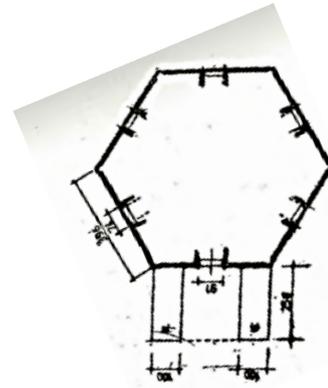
مسقط أفقي لتربة حسين شاه بمقدونيا
